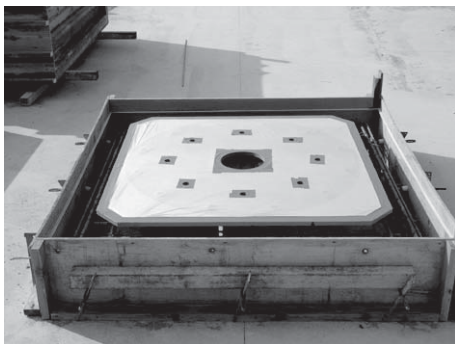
型枠, 鉄筋およびベースプレート設置状況
